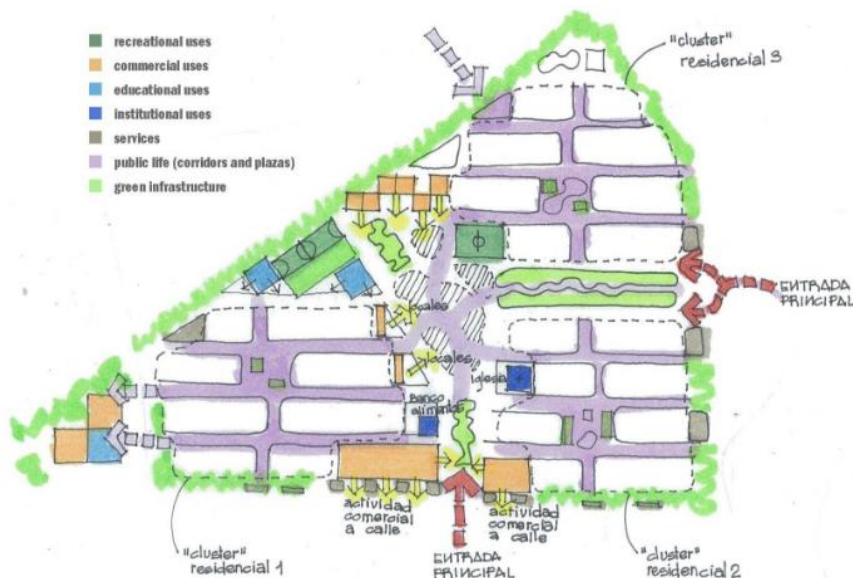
Plan masa del proyecto. Imagen: Plataforma Arquitectura
